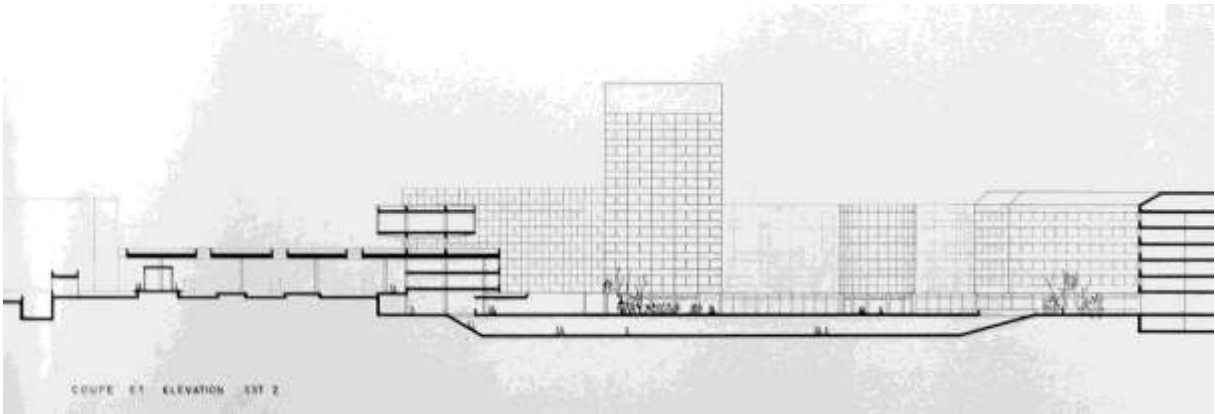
Place de la Gare, plan d'extension, coupe et élévation, la place vue en direction de l'est, J.-M. Jenny & R. Contreras architectes, 19.10.1965 (Service de l'urbanisme).
